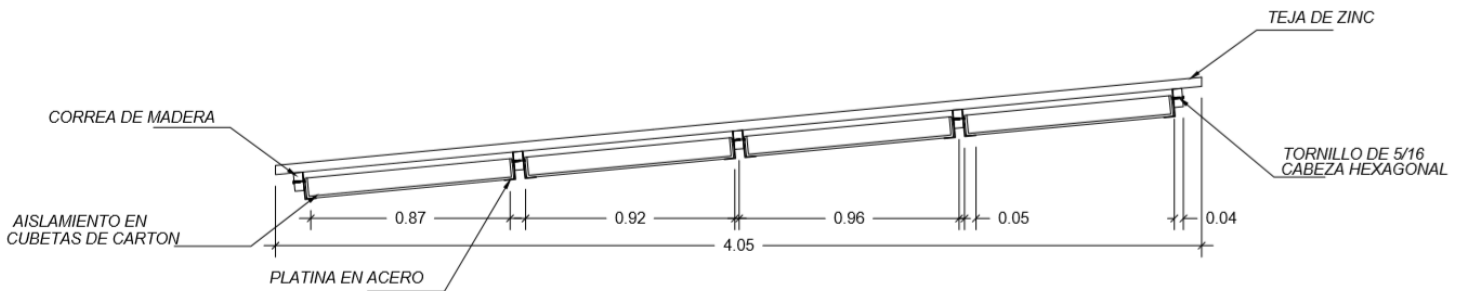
Detalle en alzado de cubierta de zinc con aislamiento acústico en cubetas de cartón. En la presente figura podemos observar el distanciamiento y el anclaje de los paneles de cartón en la cubierta. Elaboración propia.
